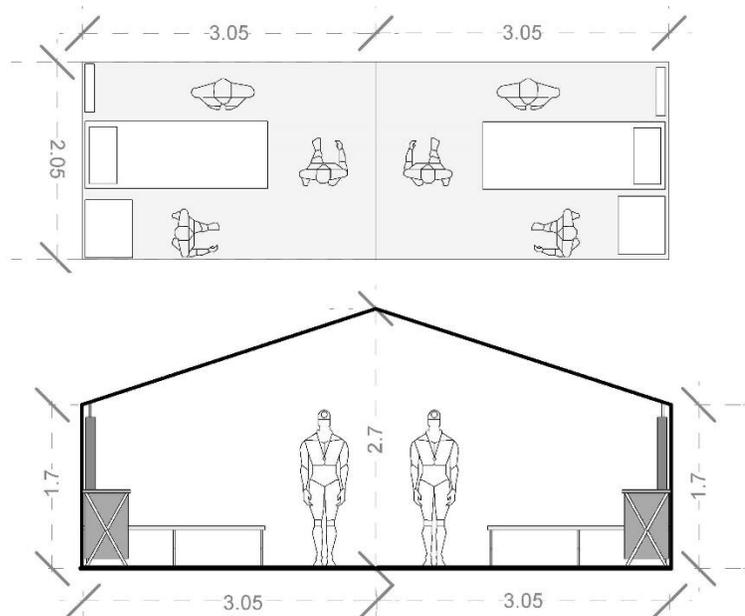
Planta y Alzado del módulo incremental para dos pacientes, incluye área de circulación.
